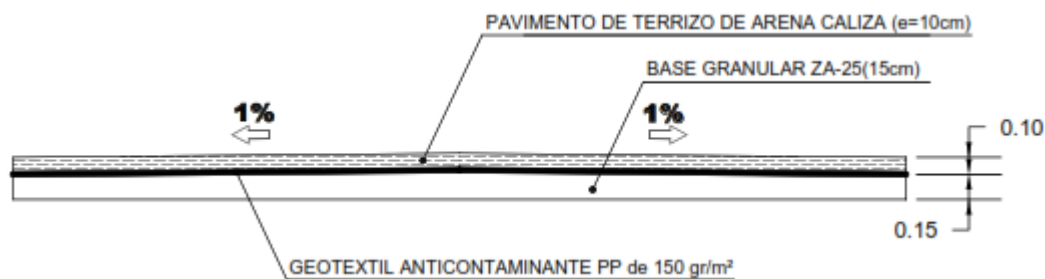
Detalle pavimento de arena. Fuente: Elaboración propia.
